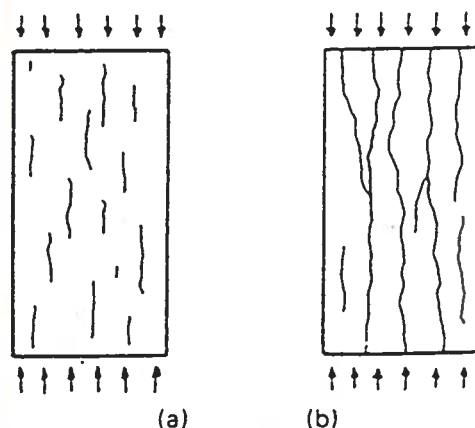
FISSURATION D'UN ECHANTILLON DANS UN ESSAI DE COMPRESSION
